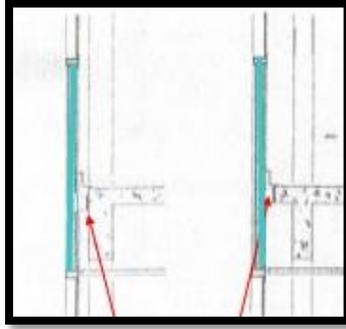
fixation d'un mur rideau sur poutre<sup>225</sup>
